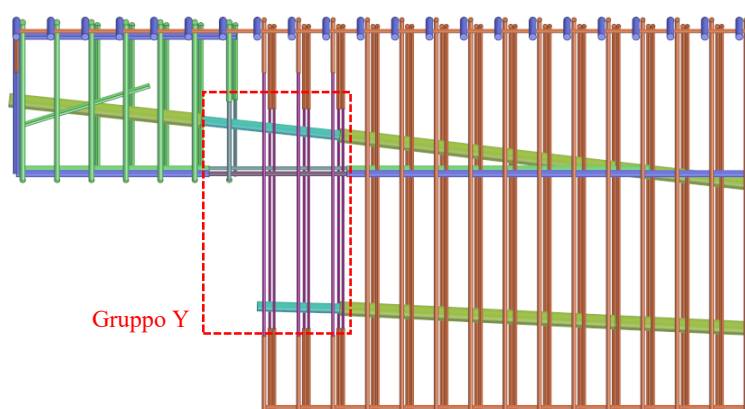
Localizzazione della corrosione nel layout di armatura, viadotto esistente
